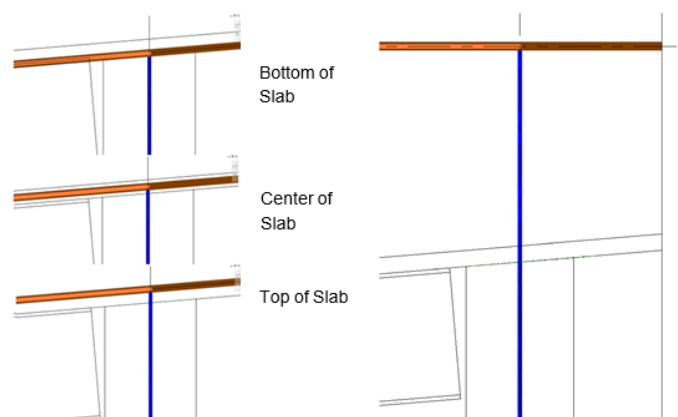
Linhas analíticas da viga (laranja) e da laje (castanho) para várias projeções da laje (Autodesk, 2014).
